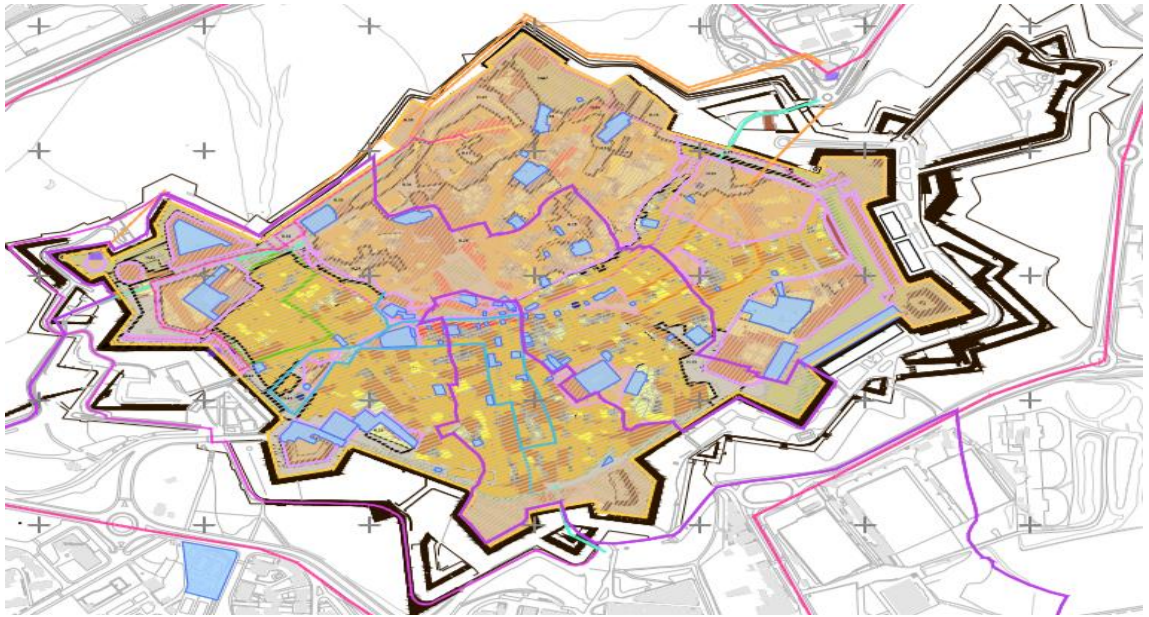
Área de intervenção do PP do Centro Histórico de Elvas (Planta de implantação) - 2016.
